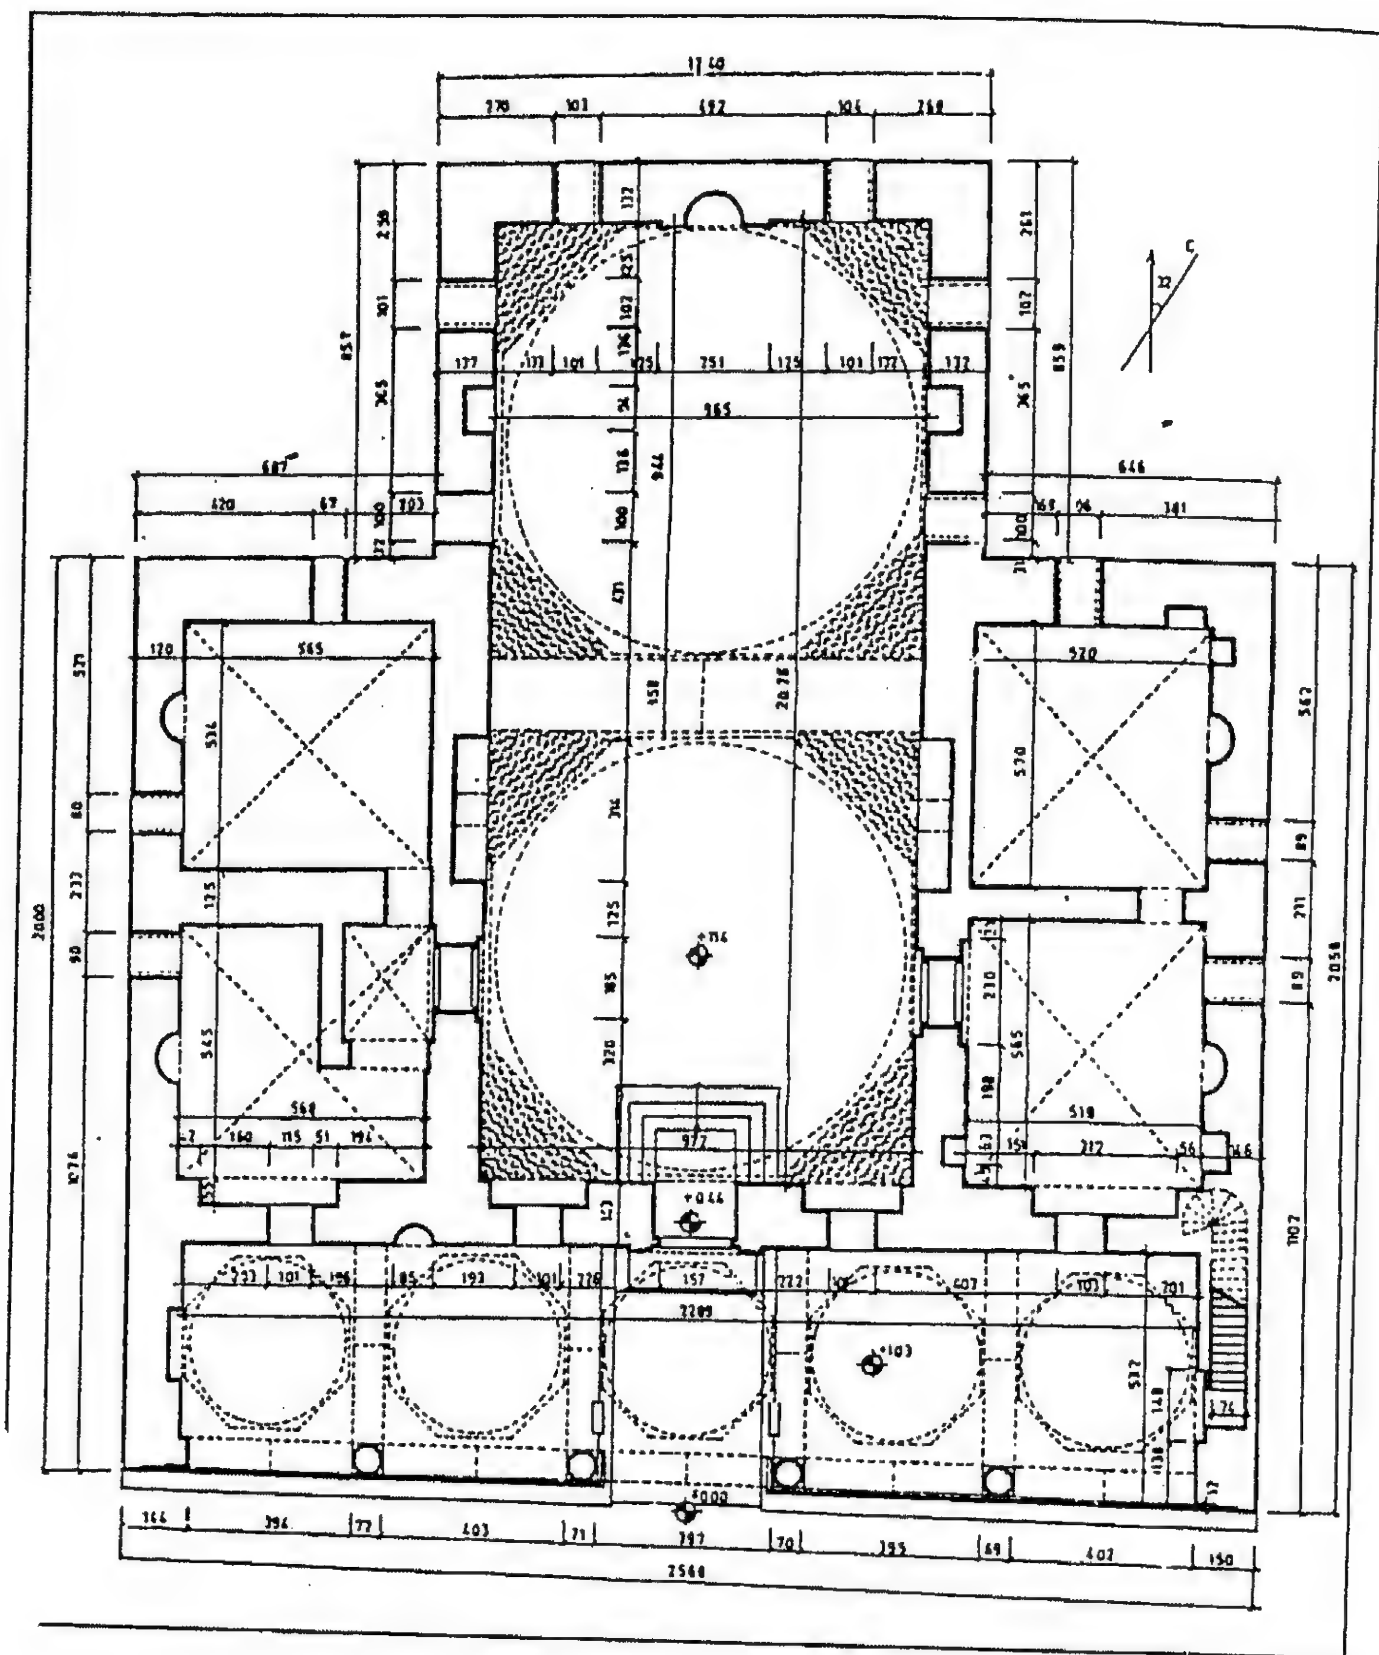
مسقط أفقي لمسجد Mezit bey في أدرنة (عن: أصلان أبا)
